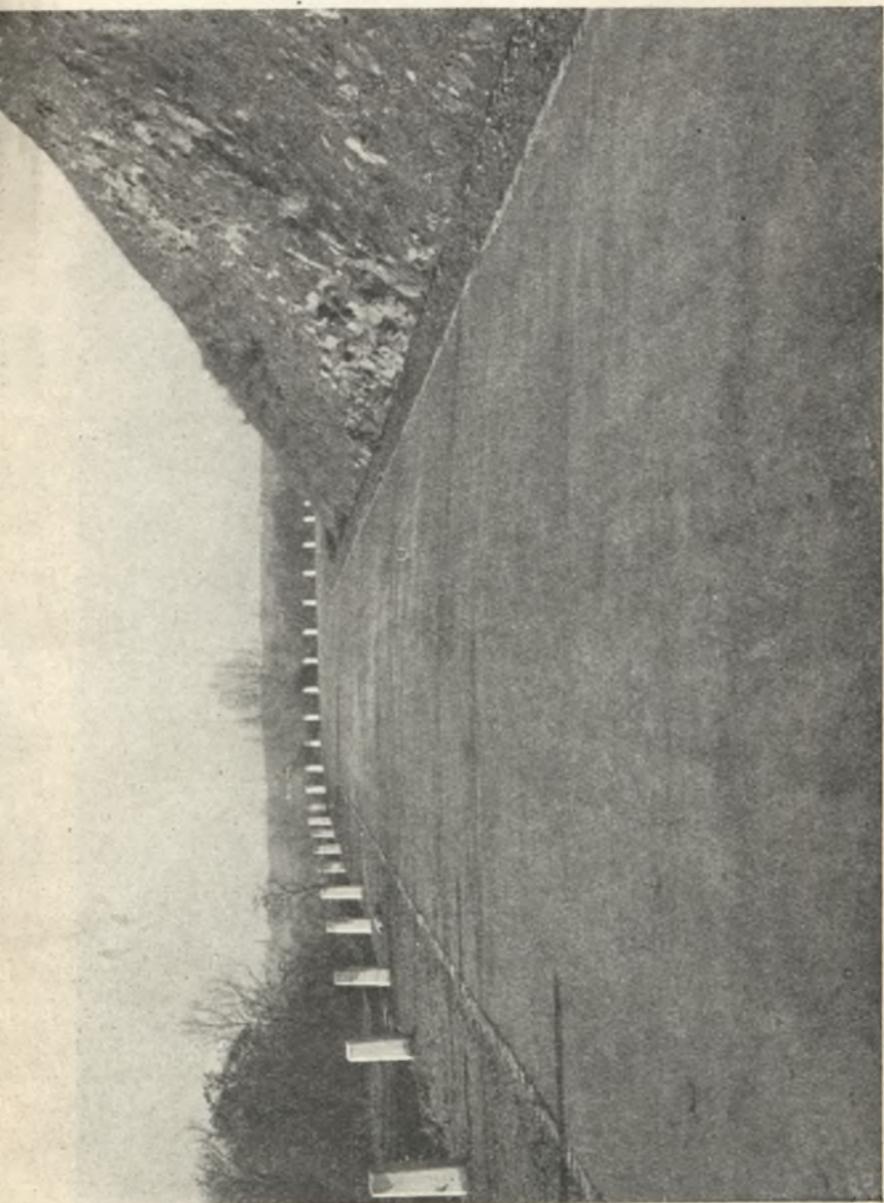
Betonstrecke der Wahntalstraße bei Siegburg.
